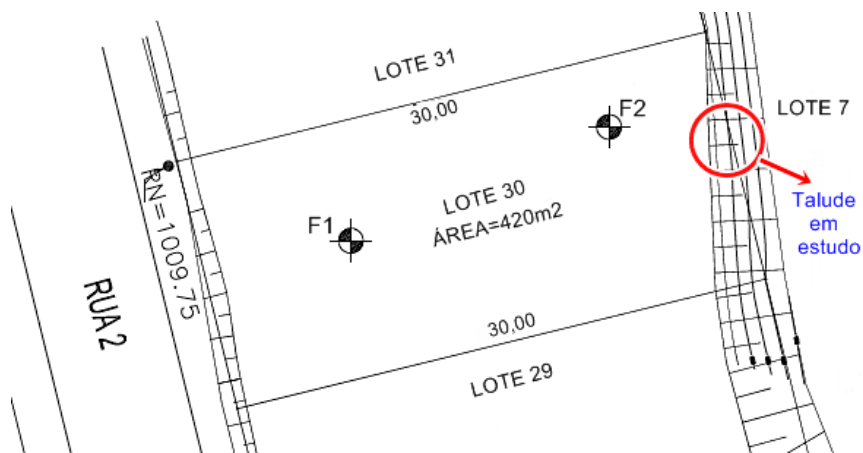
Planta de locação dos furos de sondagem do terreno em estudo.
